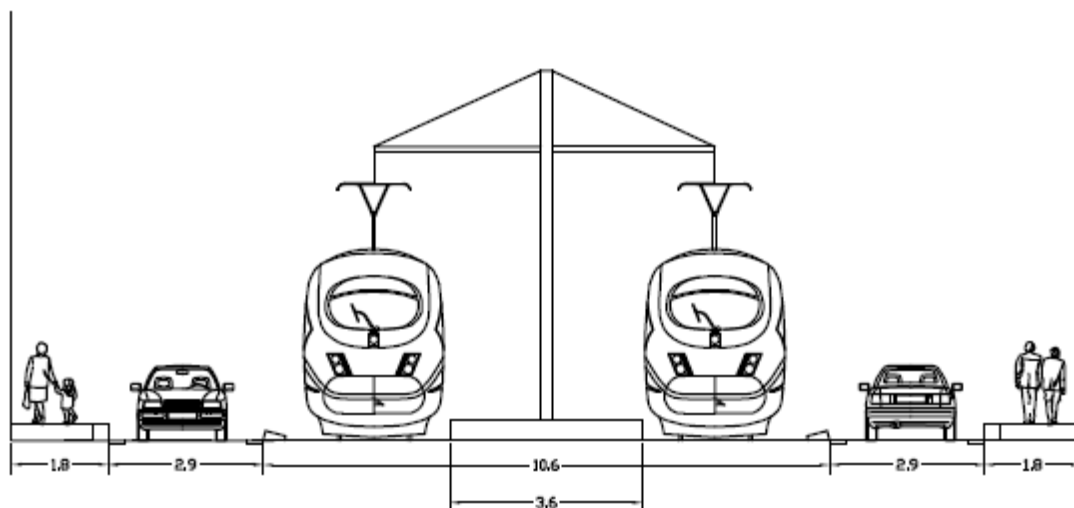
Sección de Laureà Miró bajo puente B-23 con parada de tranvía.
